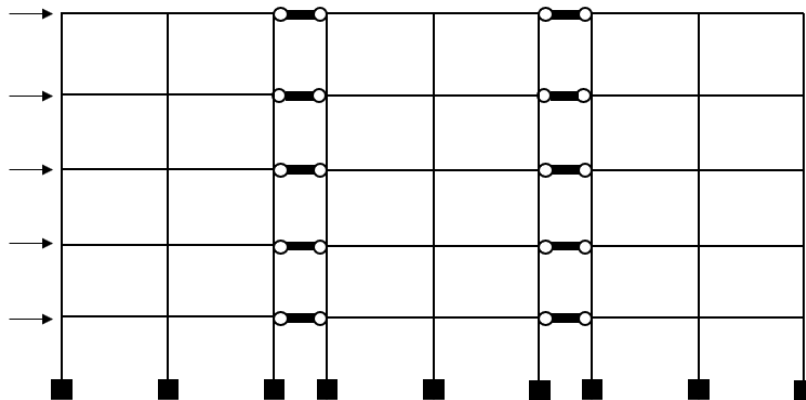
Associação de pórticos planos por meio de barras rígidas biarticuladas.
